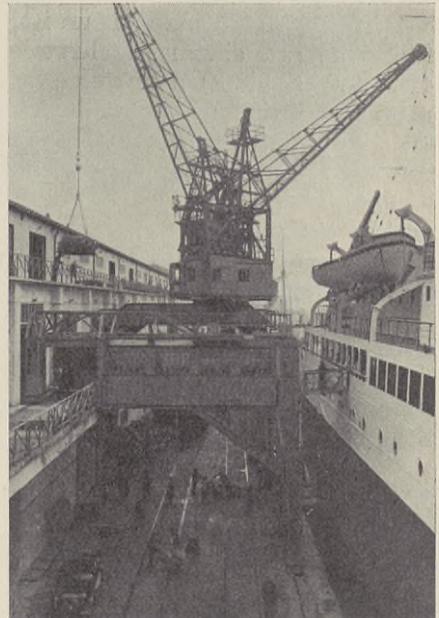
Außenansicht einer Fahrgastbrücke, dahinter Kaikräne.
